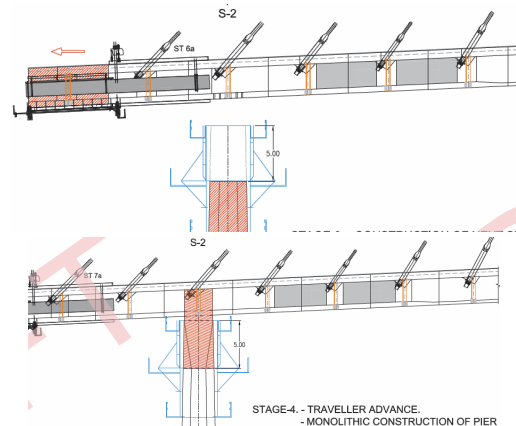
Secuencia de conexión en las pilas adyacentes a las torres.
